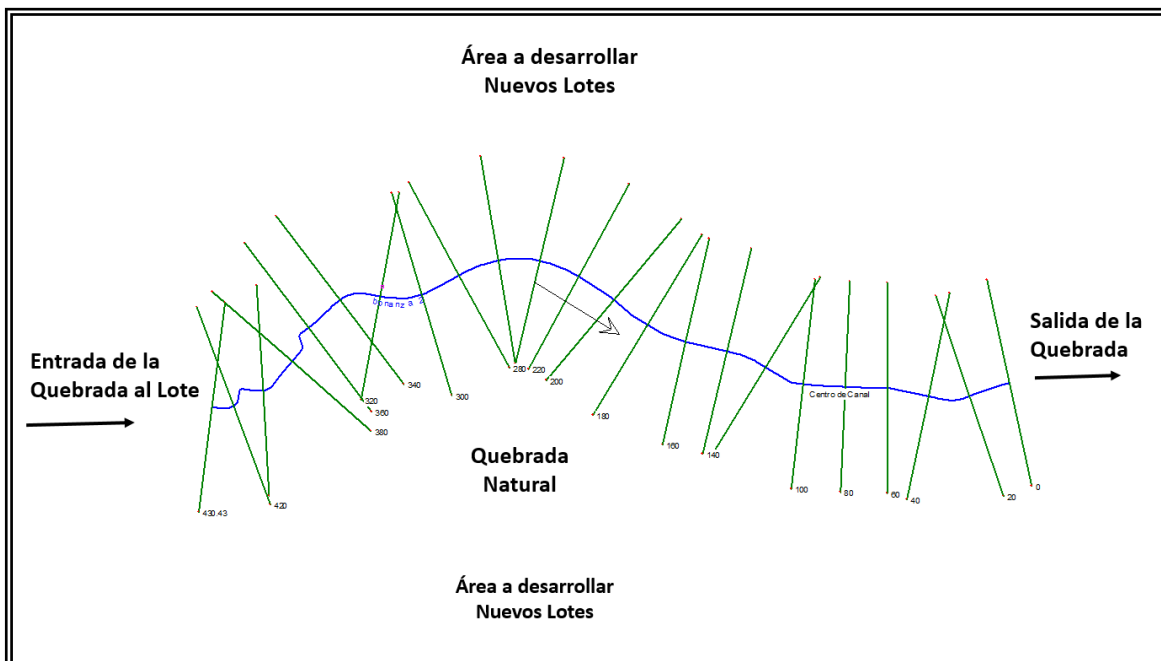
Vista de planta del Canal en Estudio en el MODELO HEC-RAS
